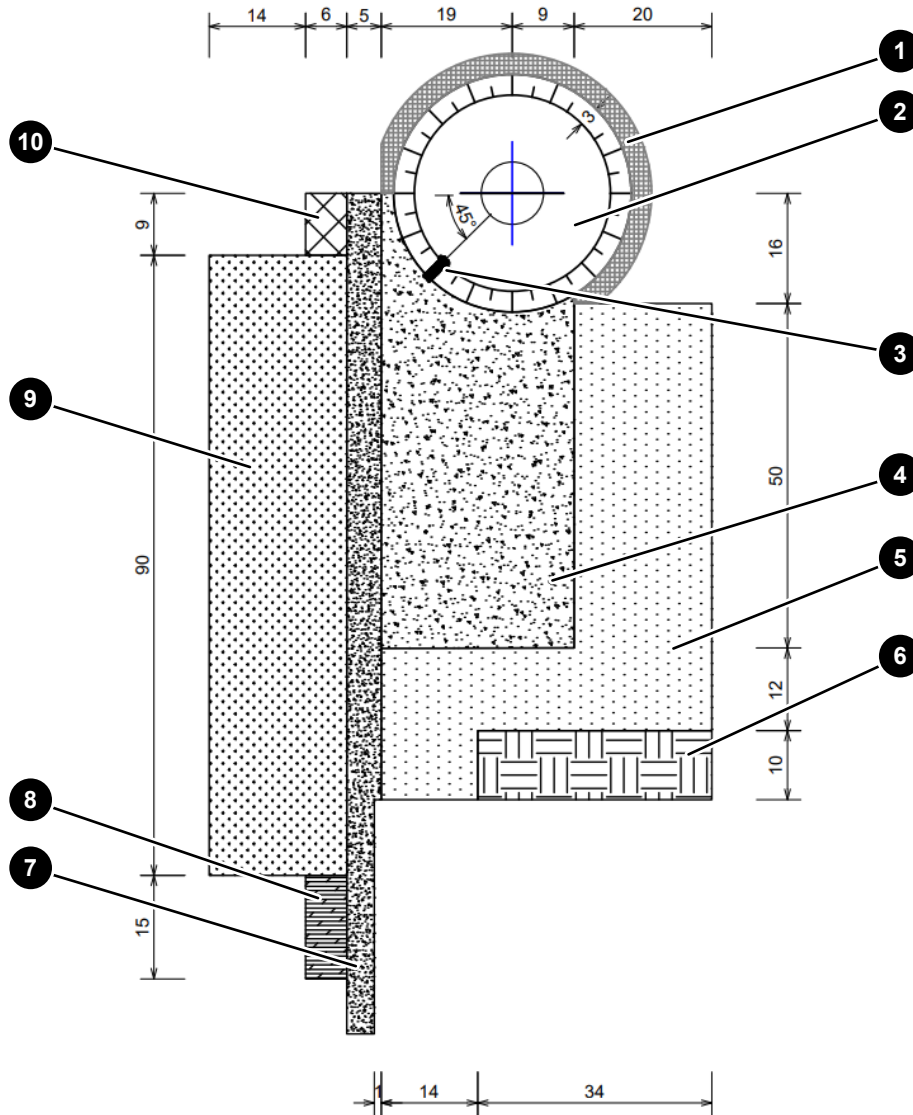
Alternative Baustellenfläche, Baumaß (alle Maßangaben in Meter)
